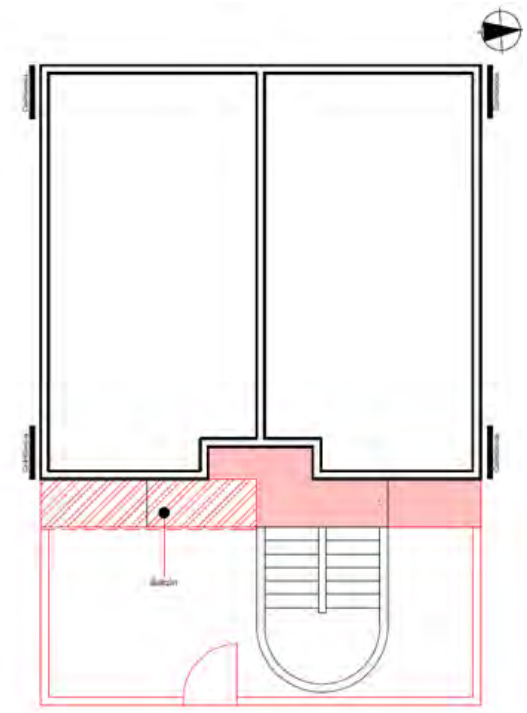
Planta del segundo nivel del Edificio D indicando el área intervenida por modificación.
